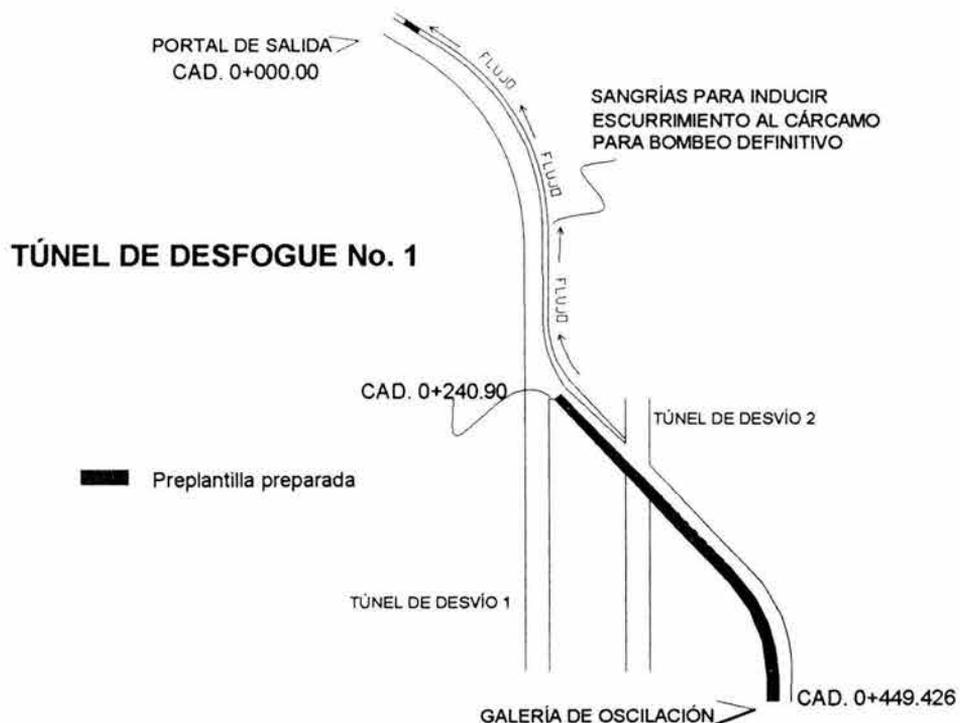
Vista en planta del Túnel de Desfogue No. 1.
